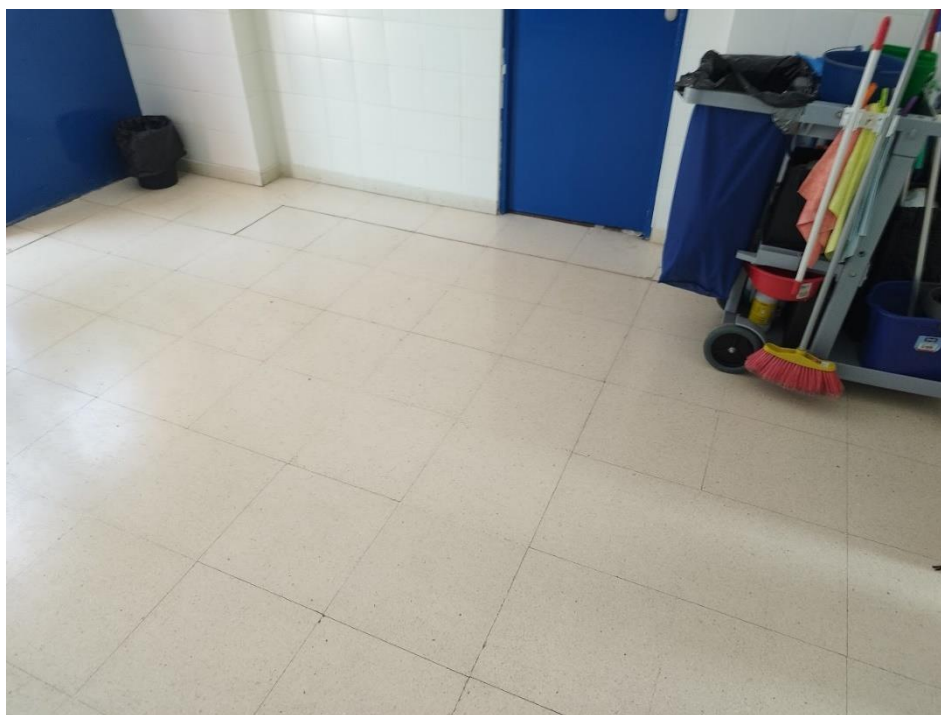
Fisuras en particiones sobre solera de planta primera
